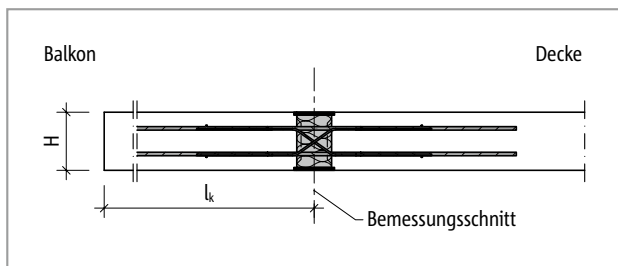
Schöck Isokorb® XT Typ D: Statisches System
